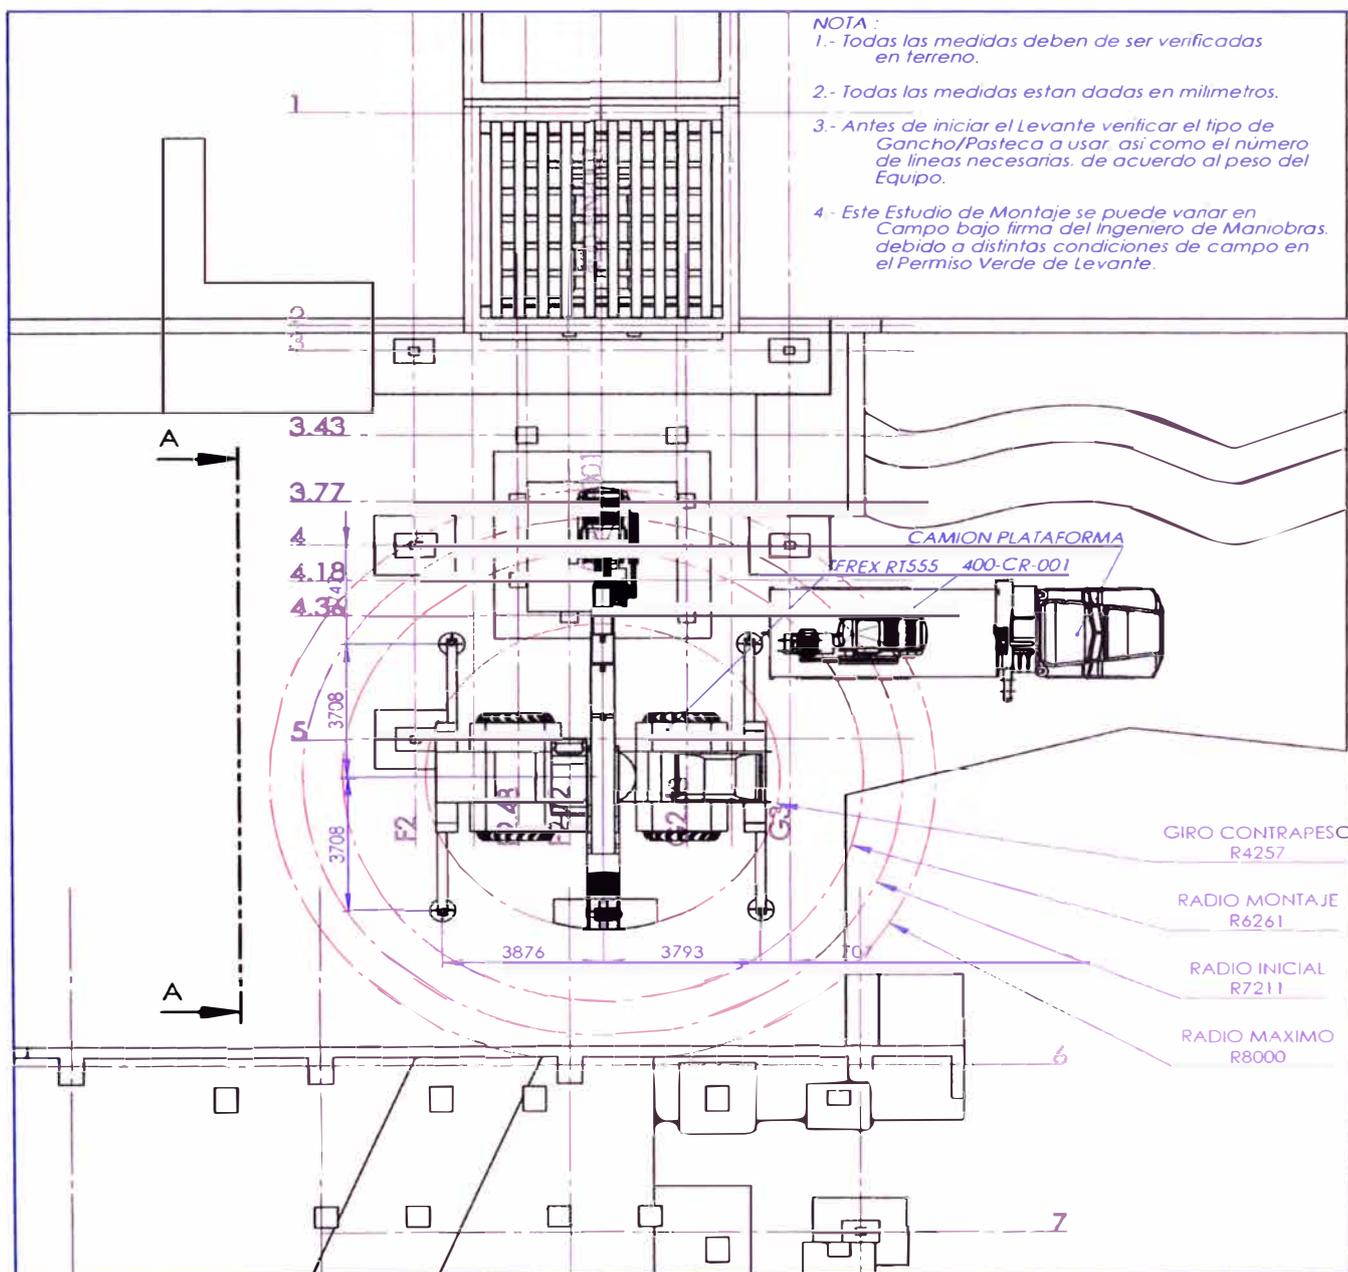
Diagrama de montaje de Chancadora Primaria, vista de planta.
